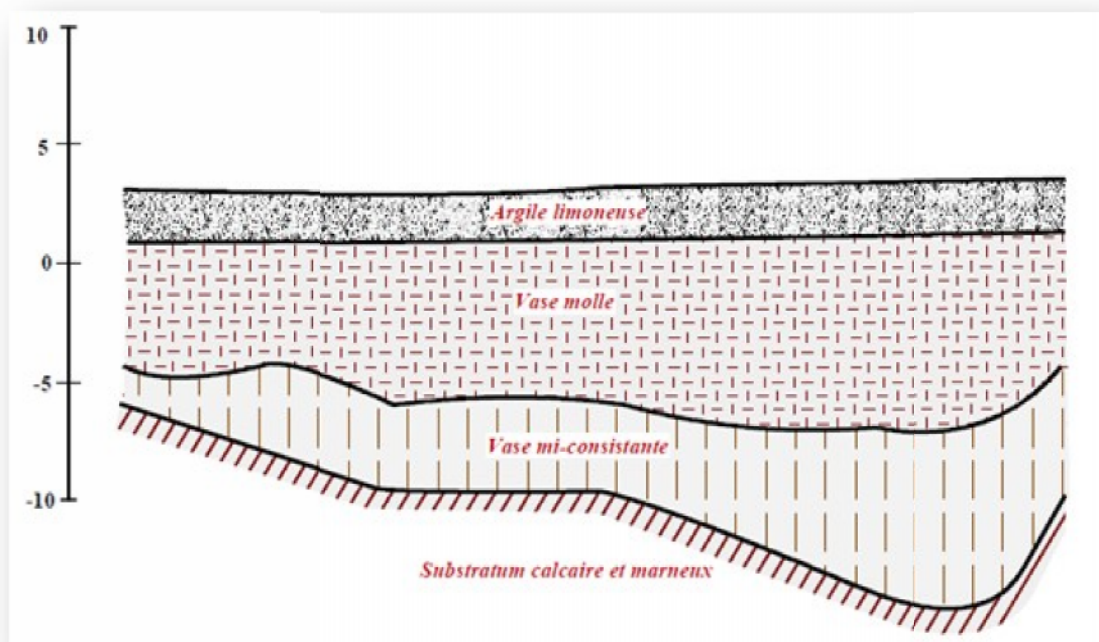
Traversée de la vallée de la Charente par l'autoroute A10 (Scetauroute, 1986)
